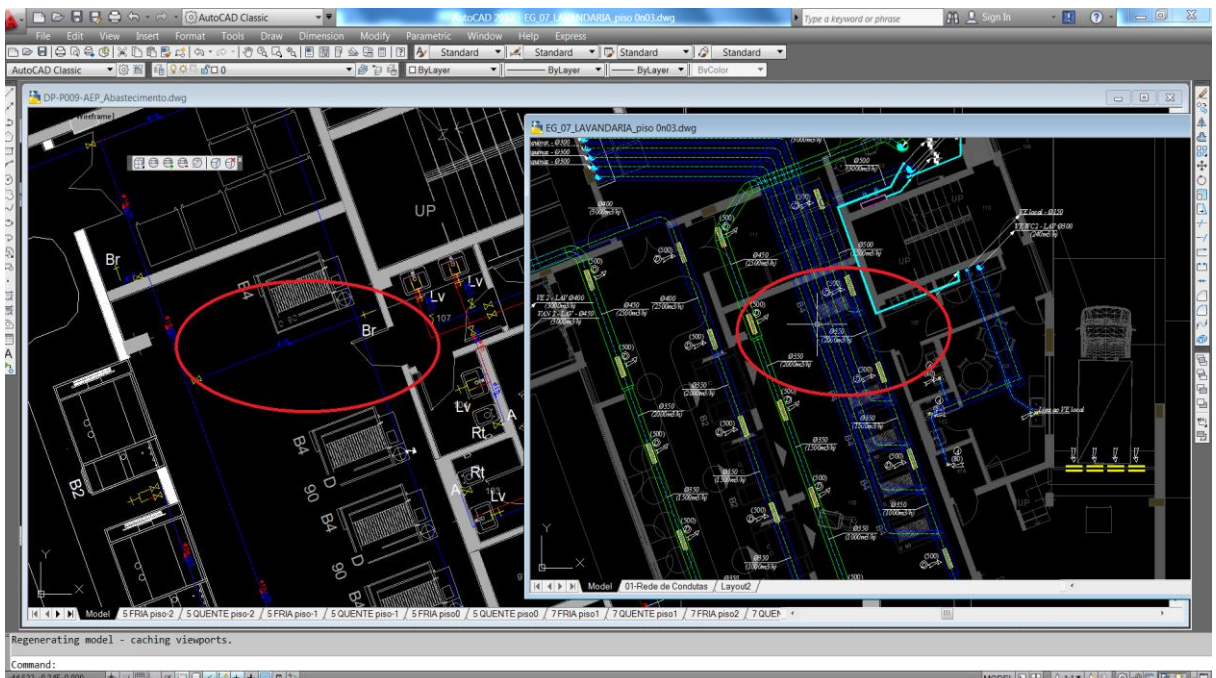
Projeto de abastecimento de água e projeto de AVAC em CAD.
